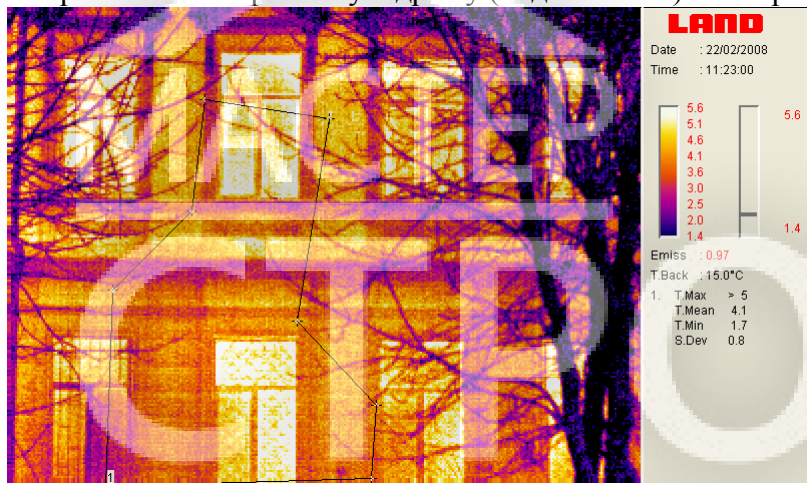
Термічне зображення фрагменту поверхні першого та другого поверху з фасаду.
